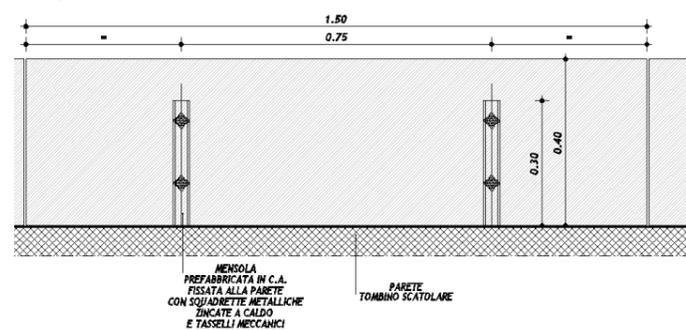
Planimetria opere di protezione per la fauna ed attraversamenti faunistici
